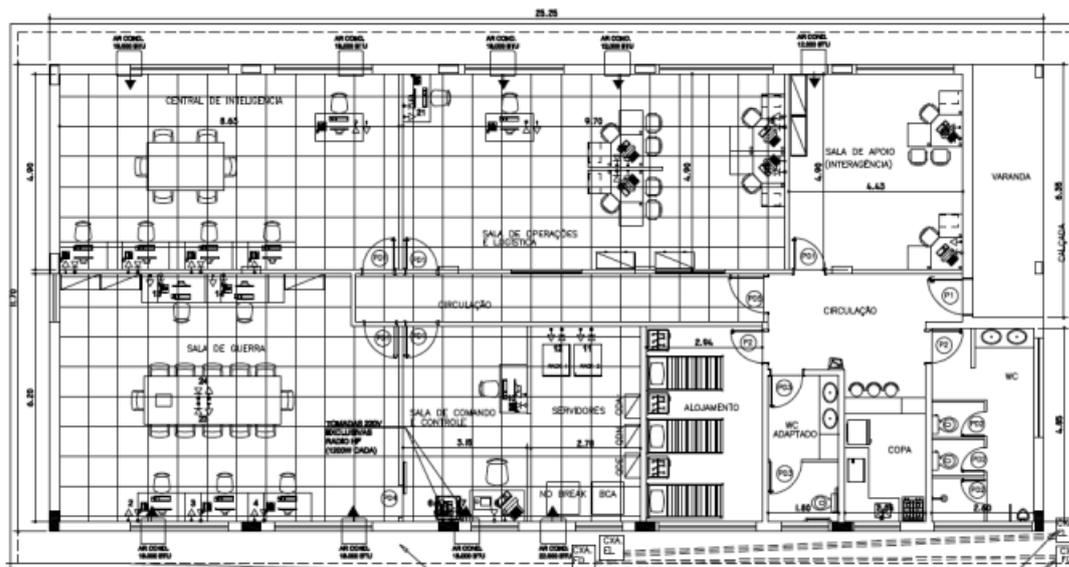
Planta de CC<sup>2</sup> fixo (OM)
